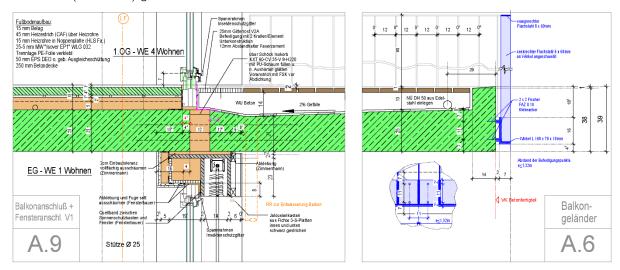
Detail Bodenaufbau und Balkonanschluss (a) / Balkonkante (b) [Architekt Wamsler].
